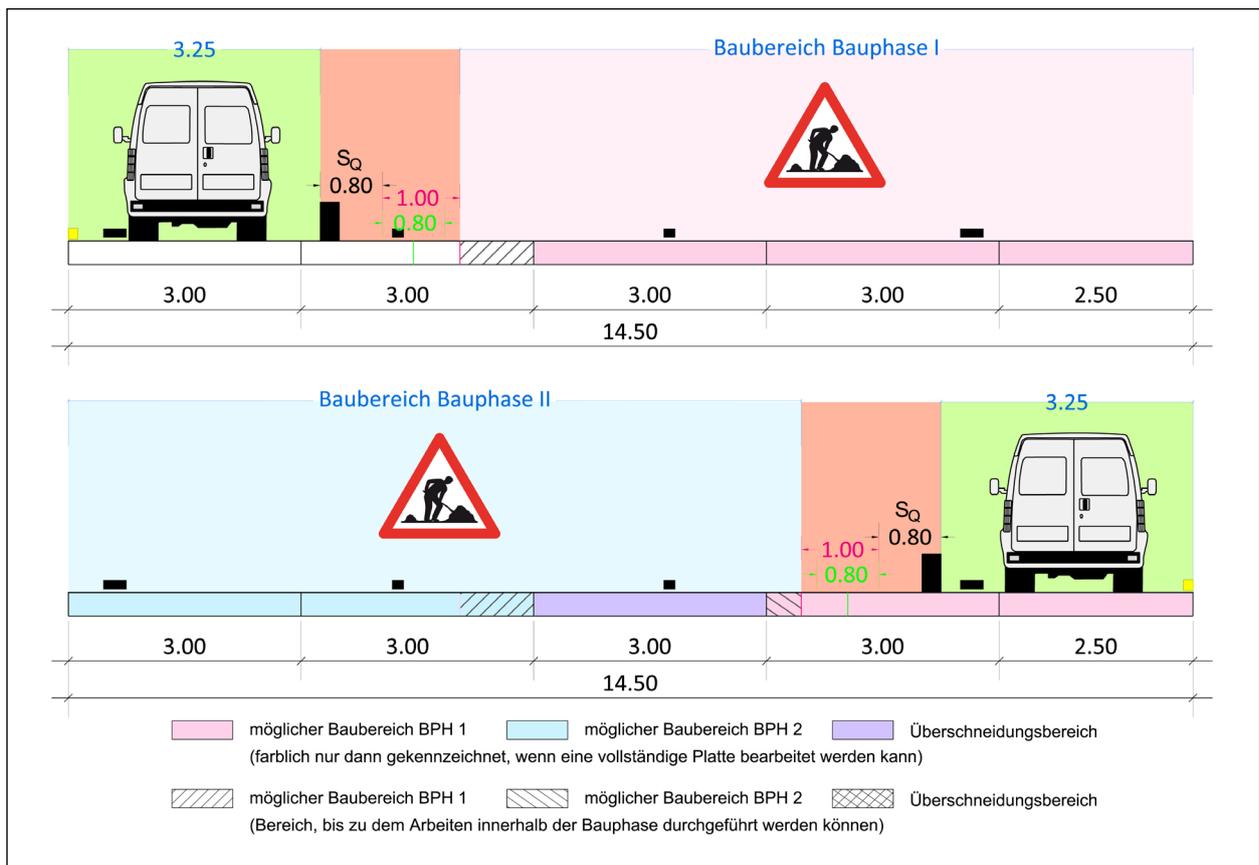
Verkehrsführung bei geänderter Plattengeometrie RQ 36
